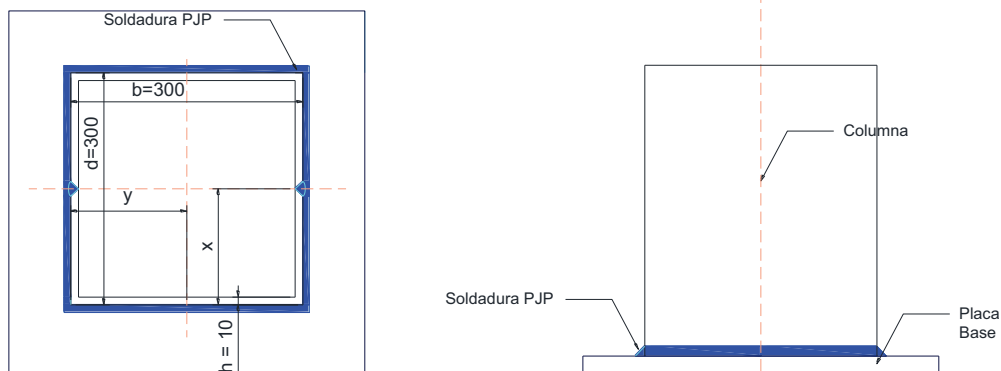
Soldadura en el contorno en conexión Columna – Placa Base
